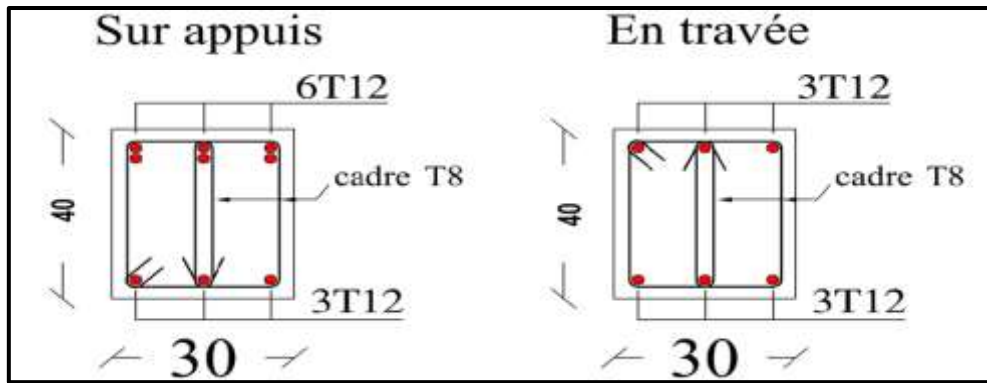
Schéma de ferrailage de la poutre palière brisée
